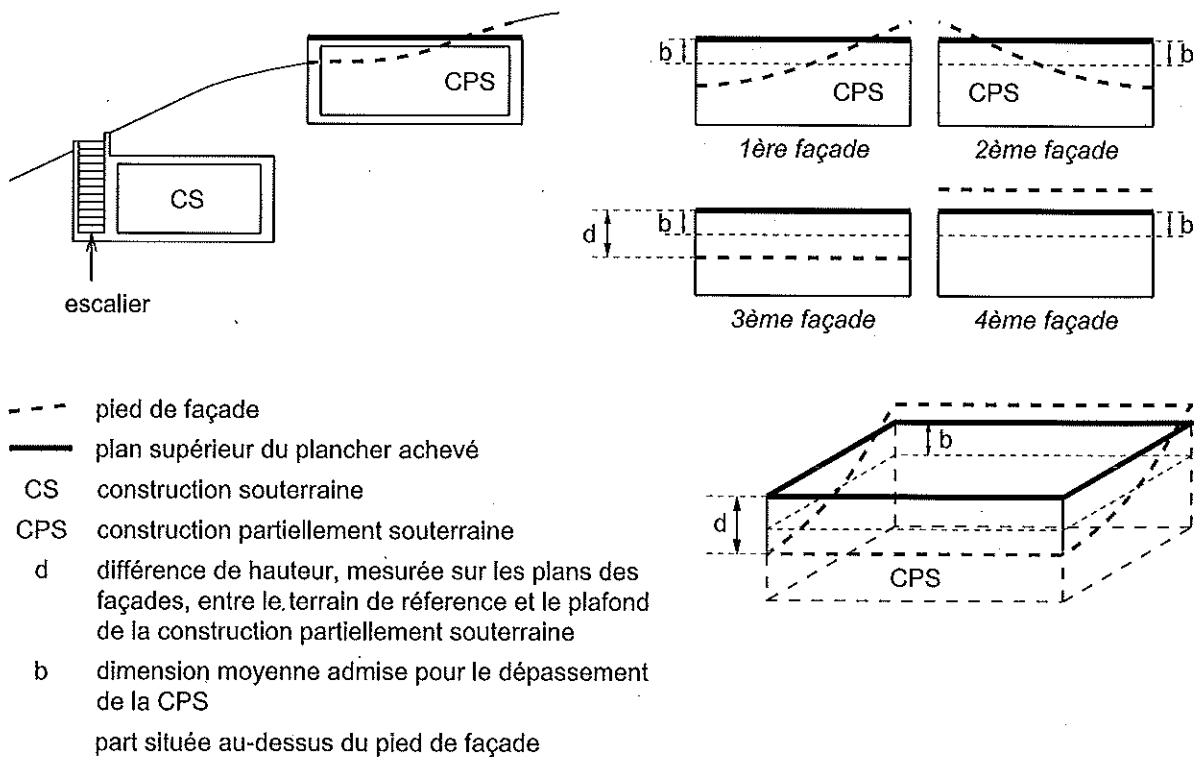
et 2.5 Constructions souterraines, constructions partiellement souterraines
